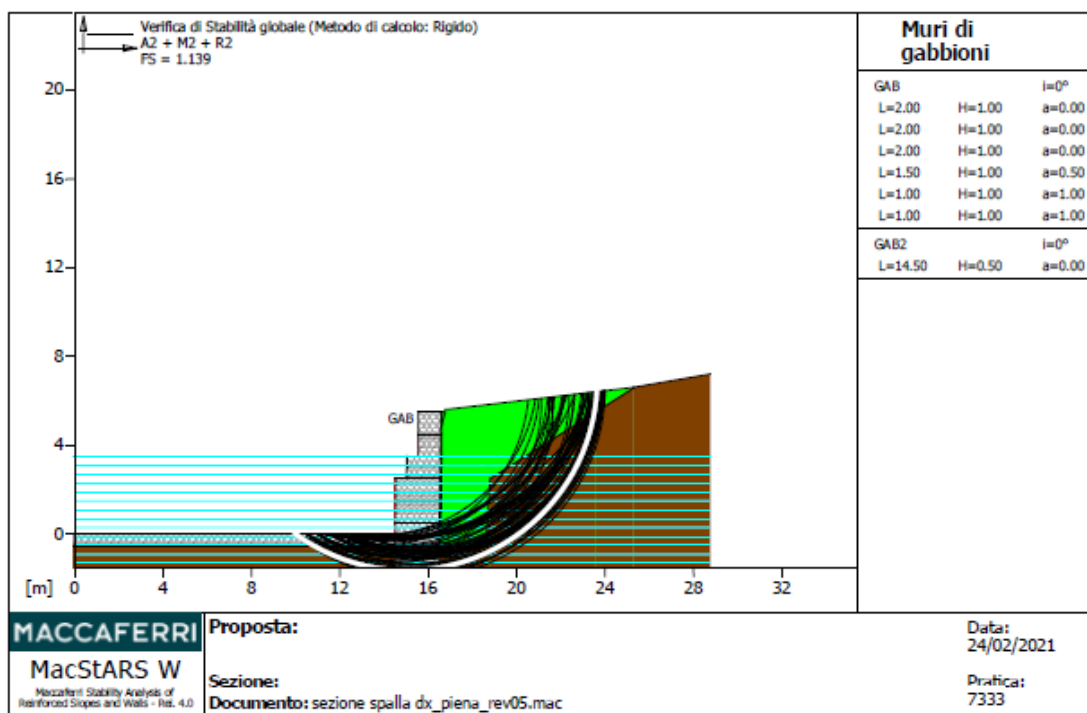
Verifica di stabilità globale sezione spalla dx- condizione di piena
